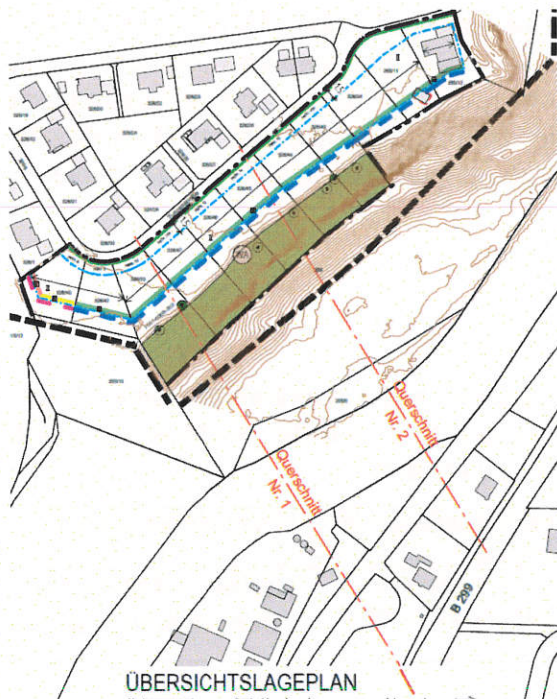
Lageplan Querschnitte (Quelle: Geländeschnitt, als Anlage zur Begründung, IB Zeller 2017)
